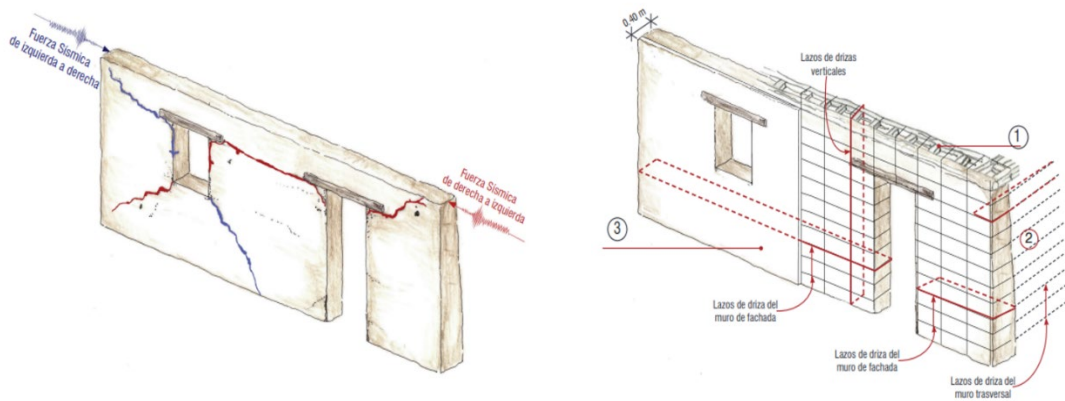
Reforzamiento por grietas diagonales en muros.
